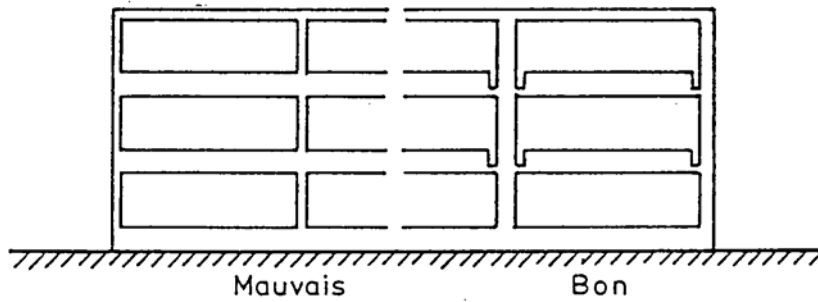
La règle « poutres faibles - poteaux forts » doit considérer la section réelle des éléments.
